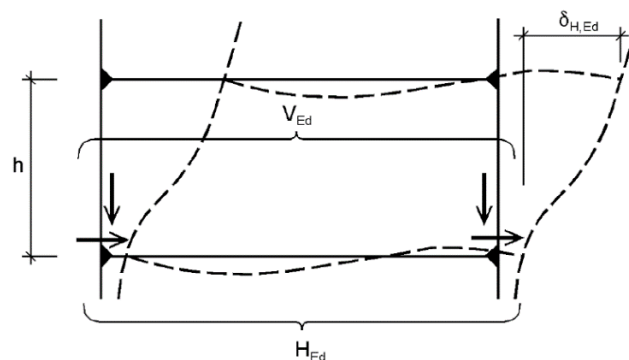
Deformação do pórtico devido a cargas verticais e horizontais
